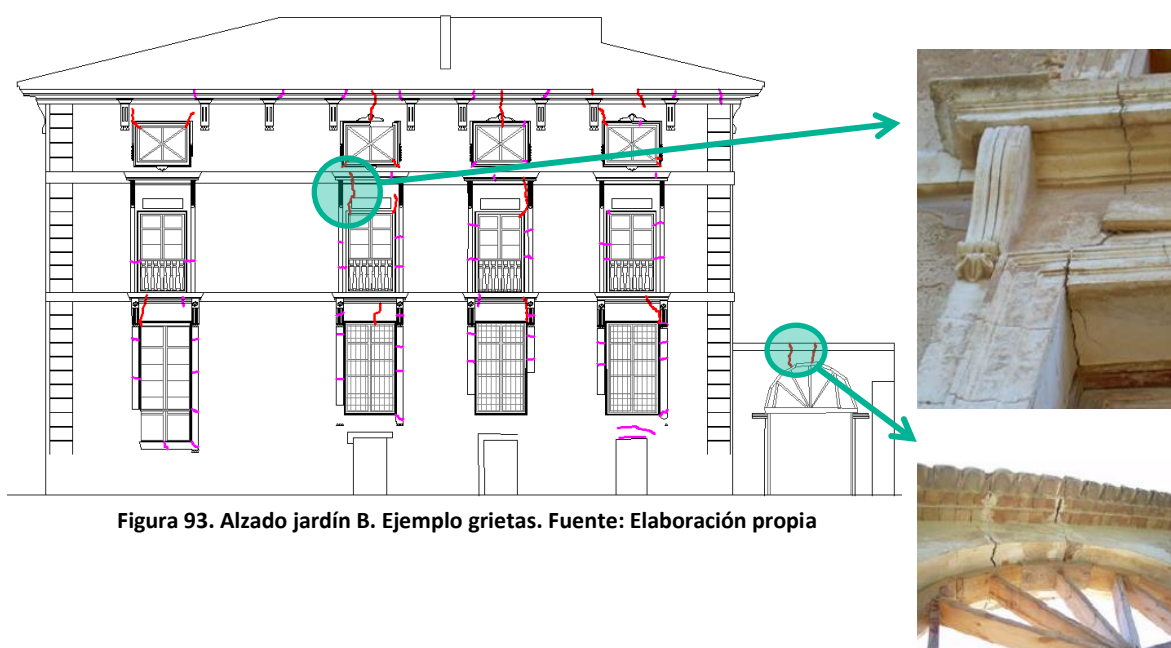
Alzado jardín B. Ejemplo grietas. Fuente: Elaboración propia
